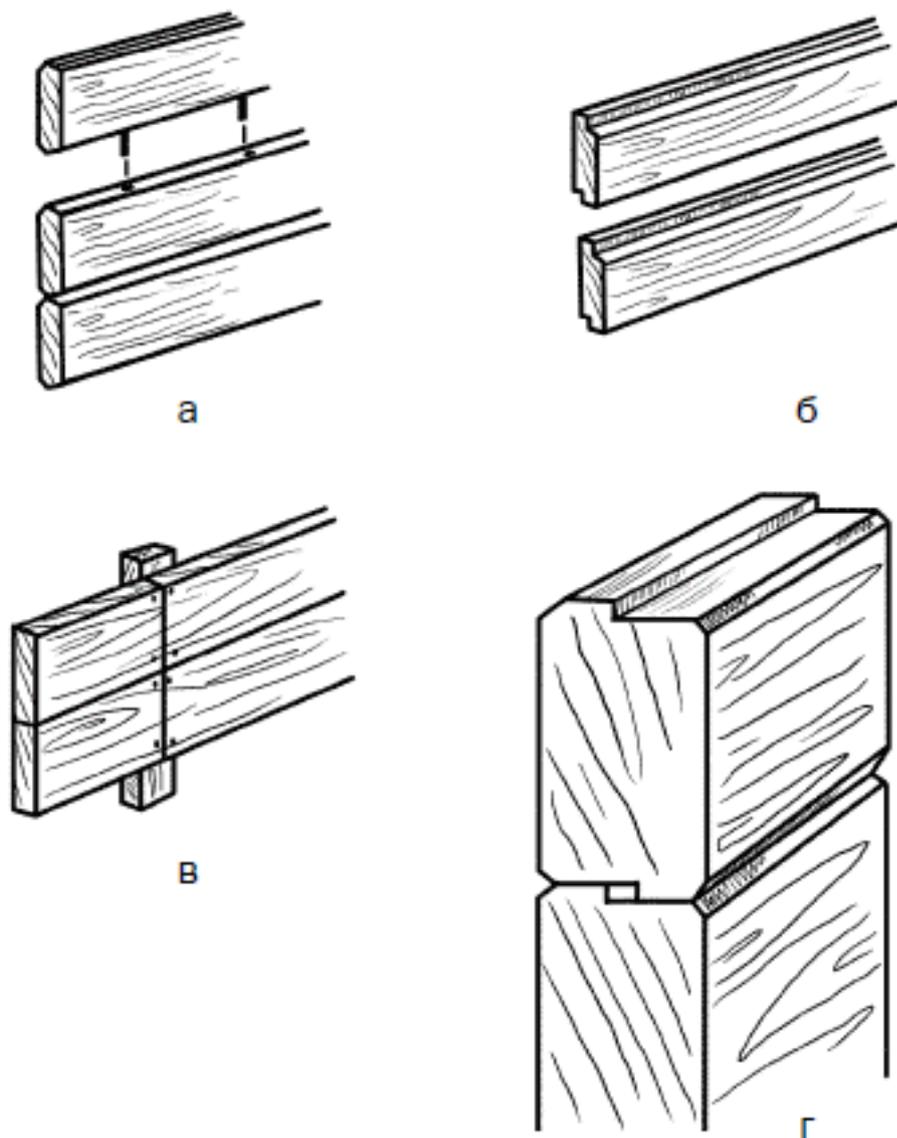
Способы соединения стеновых элементов: а – с помощью нагелей; б – выбранной четвертью; в – сплачивание на стойках каркаса; г – фальцами
